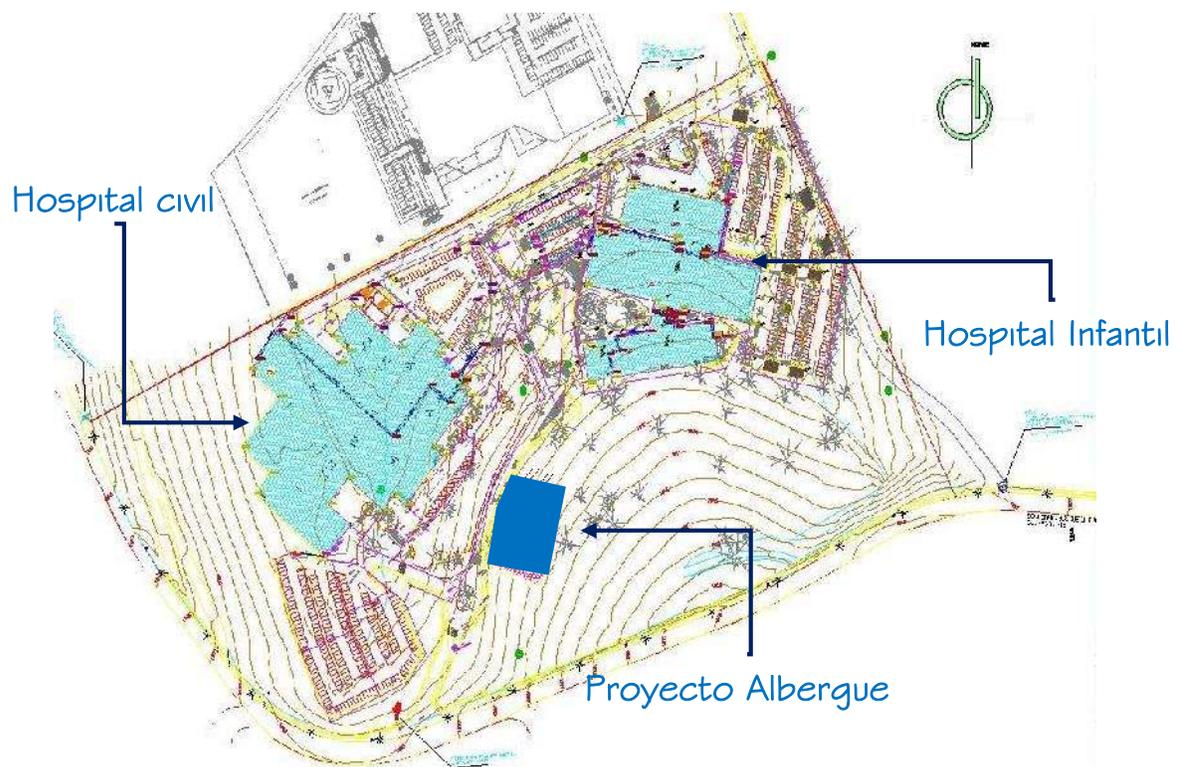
Plan Maestro del conjunto hospitalario en el Ejido de Atapaneo Fuente: Secretaria de Infraestructura Hospitalaria
